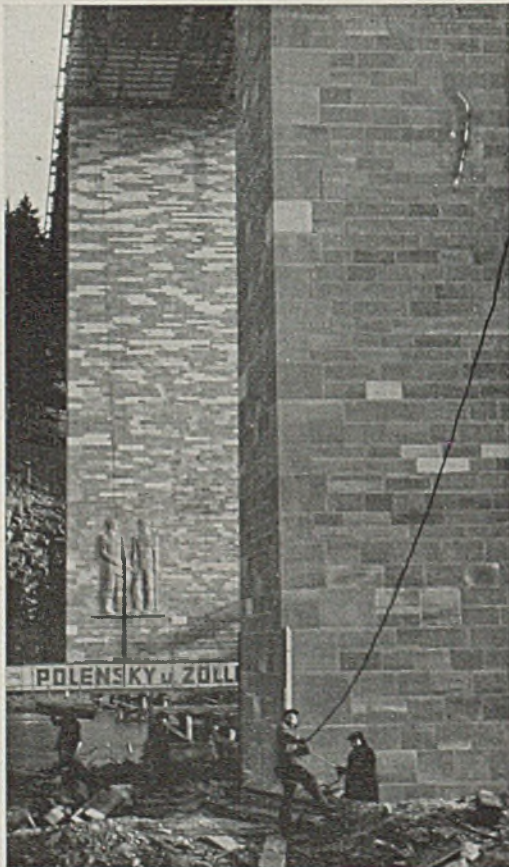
Blick vom linken Werra-Ufer auf das Bildwerk am Pfeiler I.
